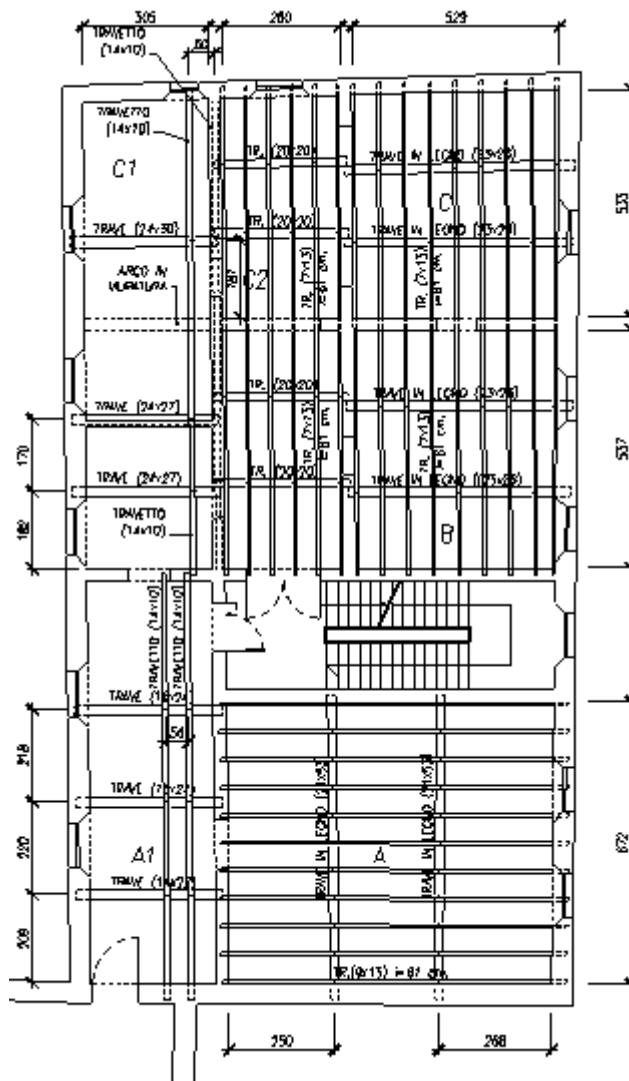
Pianta solaio piano secondo corpo N-E "Ex-Cucine": interventi strutturali
